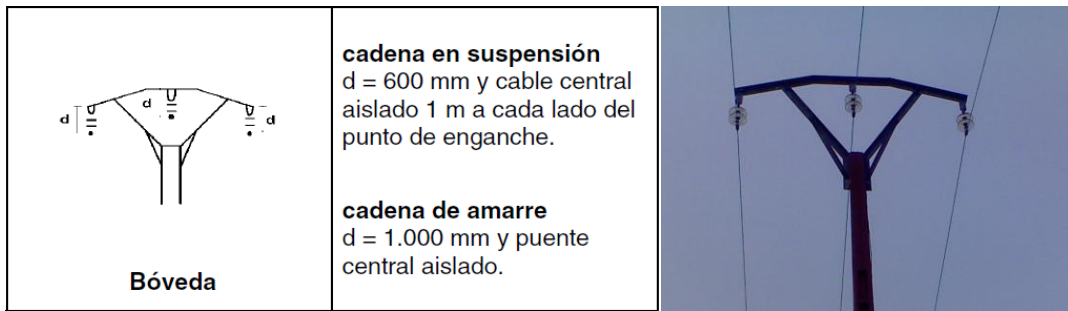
y Foto 10. Disposición de conductores en un mismo plano horizontal.
